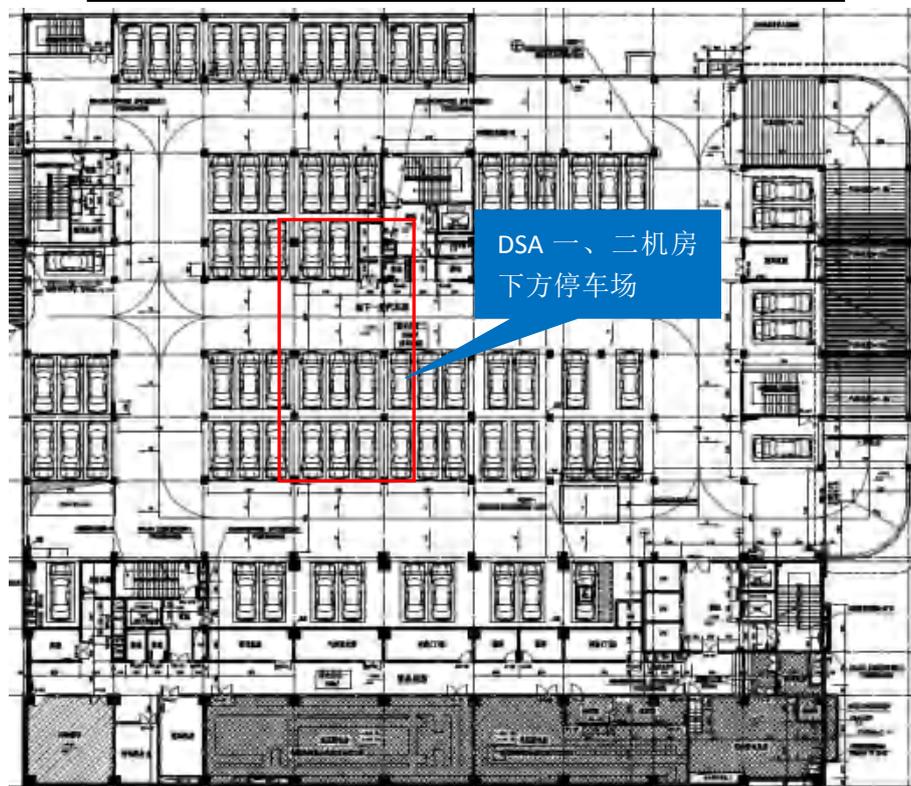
DSA 一、二机房下方楼层（负一层）平面布置图
